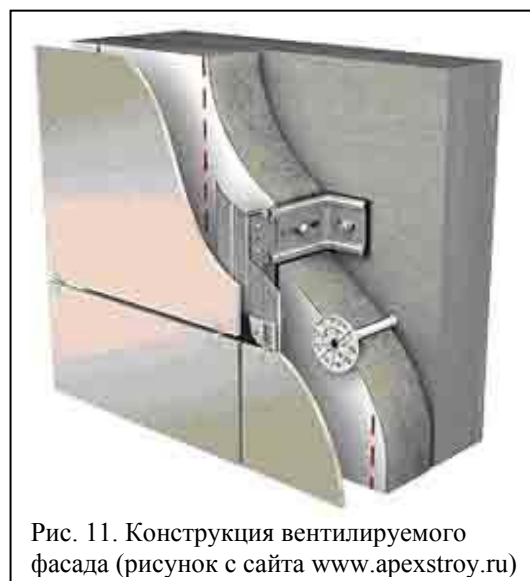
Конструкция вентилируемого фасада (рисунок с сайта www.apexstroy.ru)
